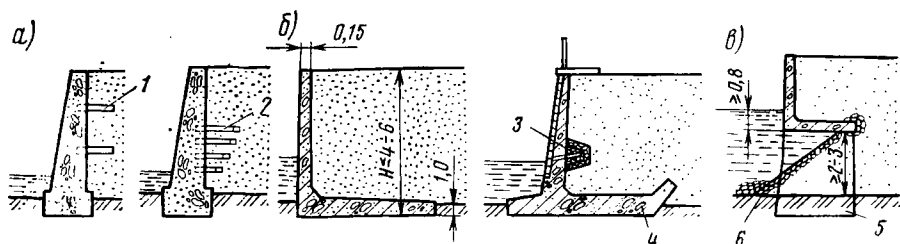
Комбинированные и железобетонные монолитные подпорные стены: 1 — разгружающая консольная площадка; 2 — анкерные железобетонные элементы; 3 — дренаж и водоотвод из засыпки; 4 — анкерная часть фундамента; 5 — боек; 6 — каменная наброска
